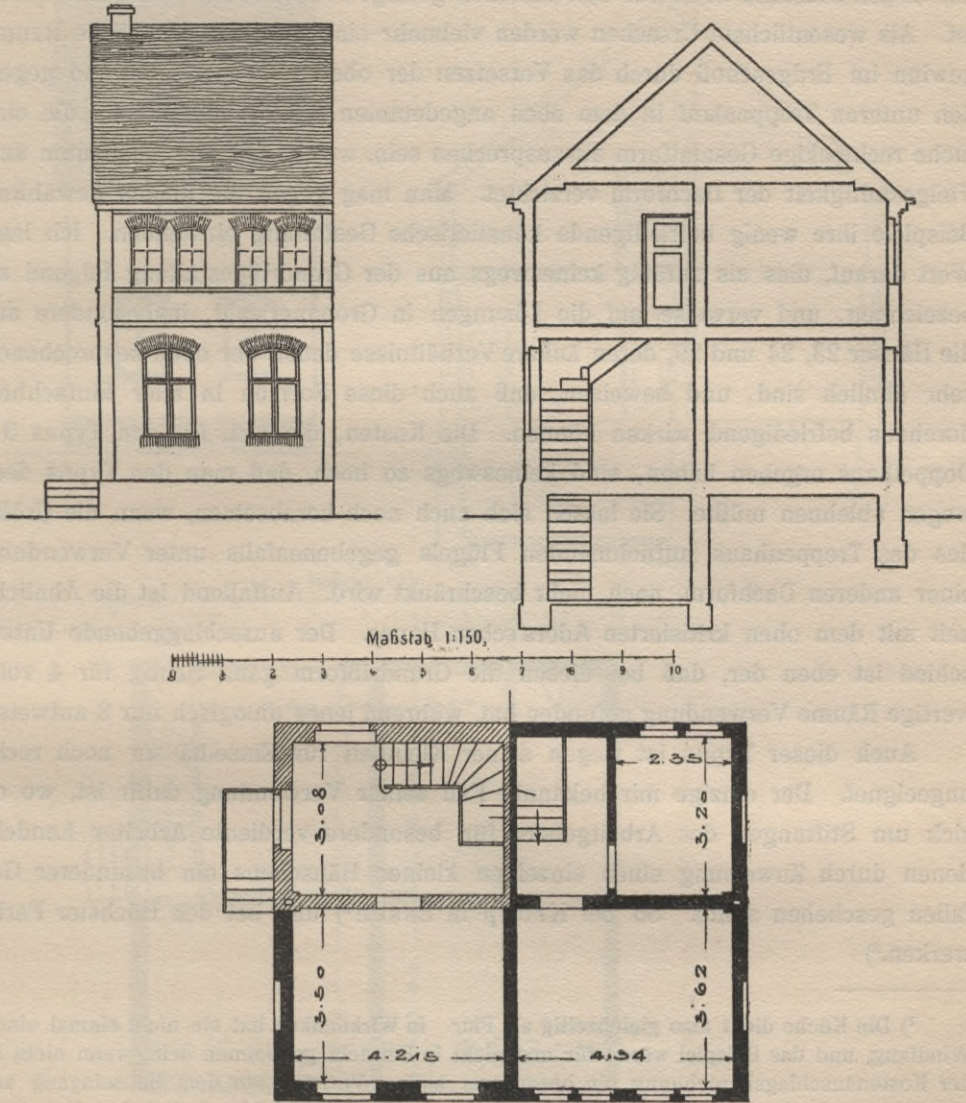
Typ 3c, Doppelhaus: Vier Wohnräume, je zwei im Erd- und Obergeschoß; beide Grundrisse sind jedoch voneinander verschieden (Doppelhaus). Beispiel nach einem Hause der Hildener Aktienbaugesellschaft. Bauart 1. (Vgl. Festschrift a. a. O.).
